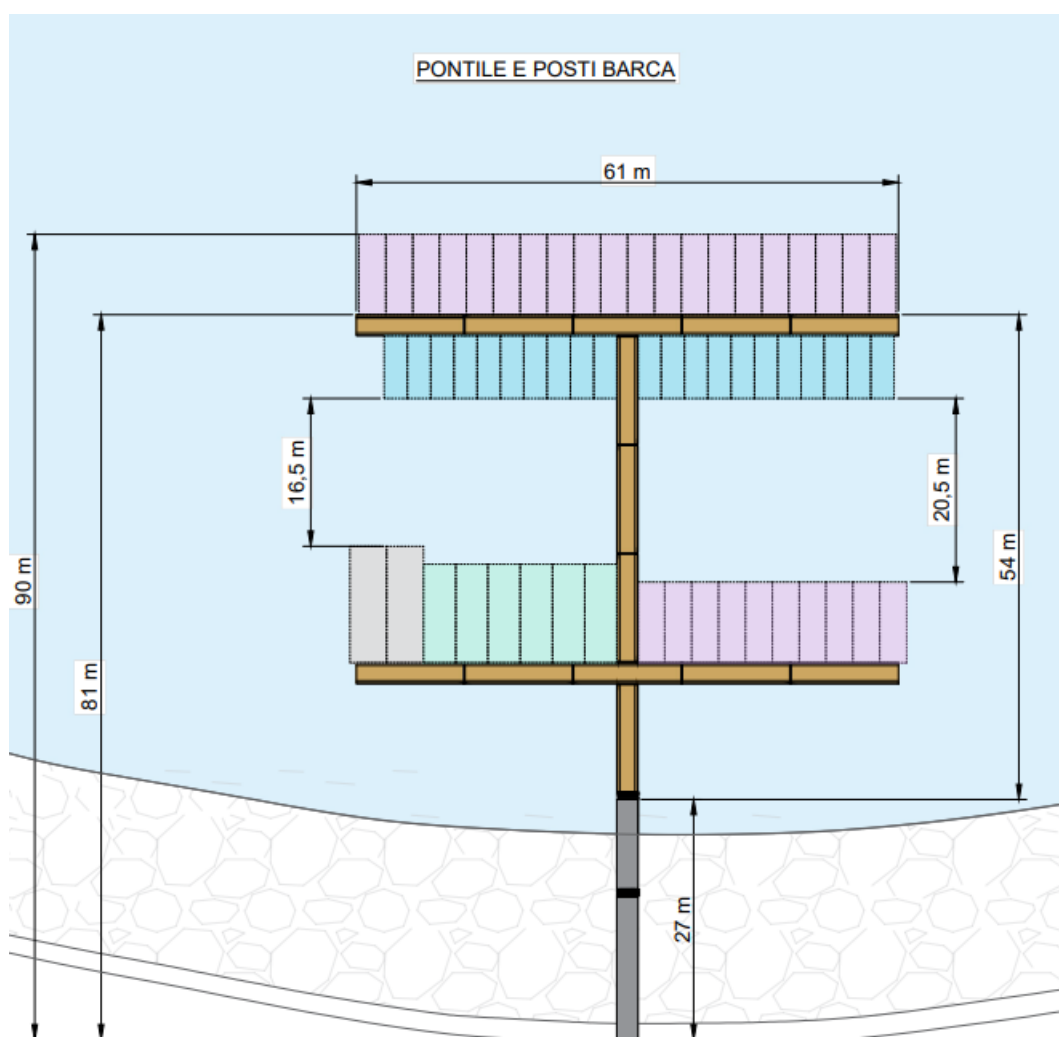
Planimetria delle opere da realizzare nello specchio d'acqua
